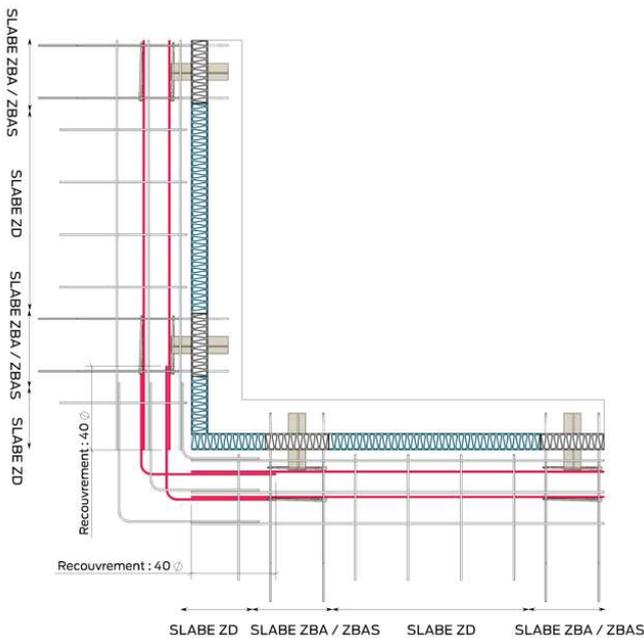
Ferrailage d'un angle sortant (vue en plan)
